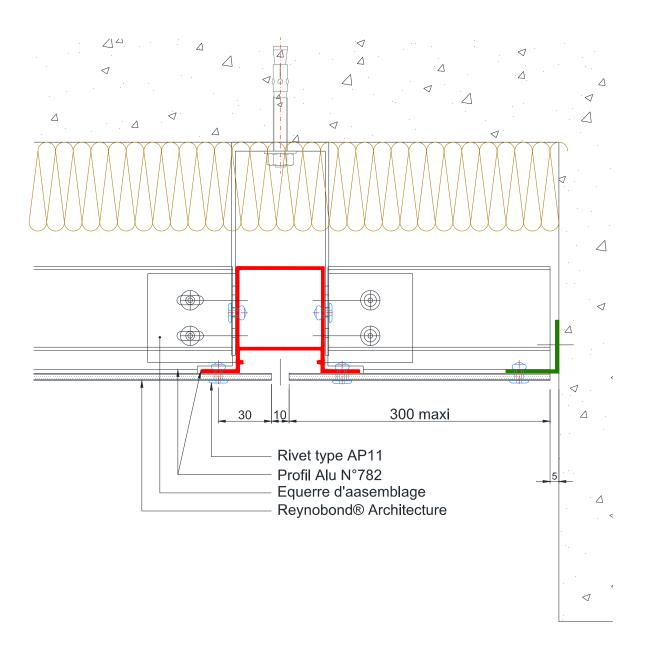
Arrêt latéral sur mur béton – Coupe horizontale – Système riveté RV 60 4c
